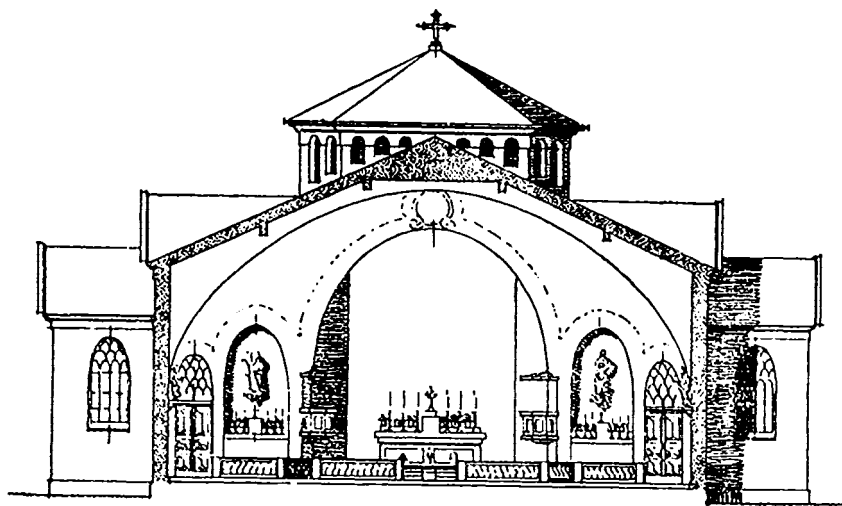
Igreja Paroquial: Elevação e Corte Transversal.
